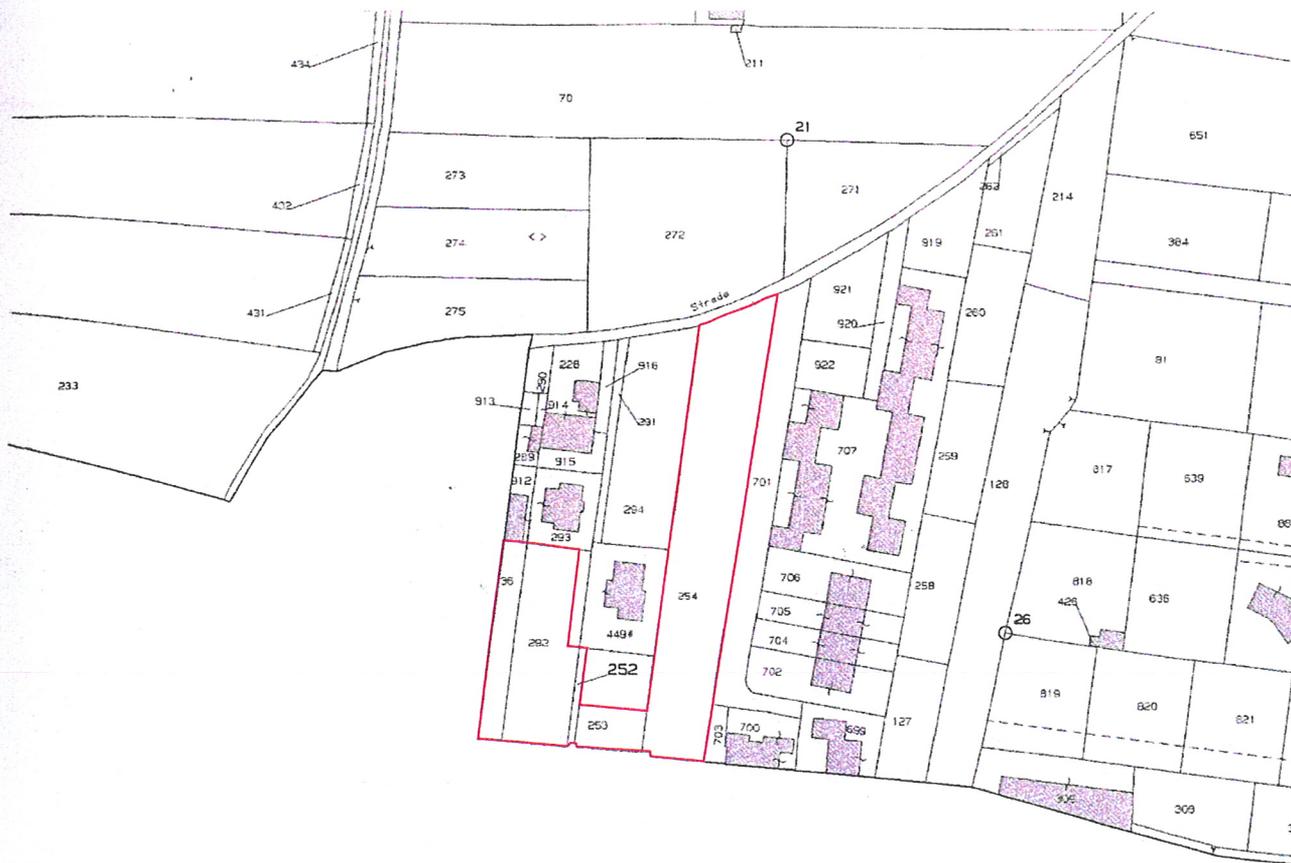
Planimetria catastale con individuazione dell'area di progetto
